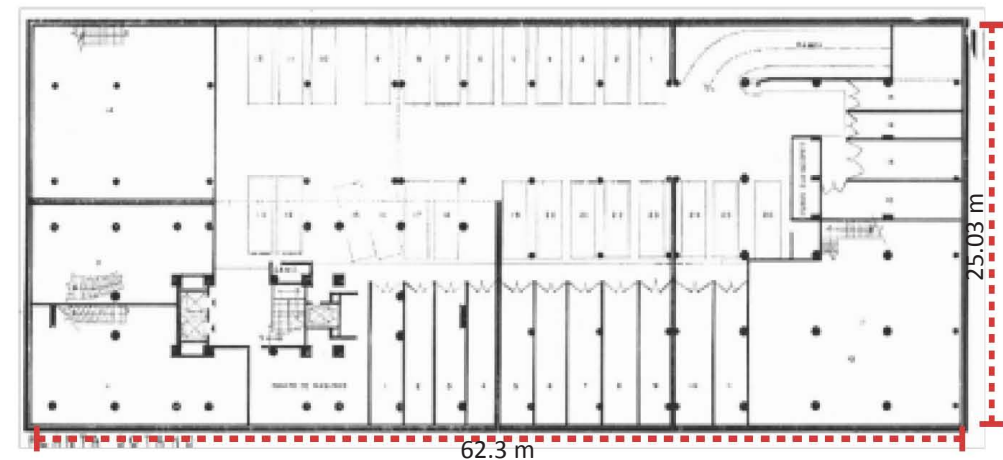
Planta de Sótano del Caso Estudio. Fuente: Creación propia.
